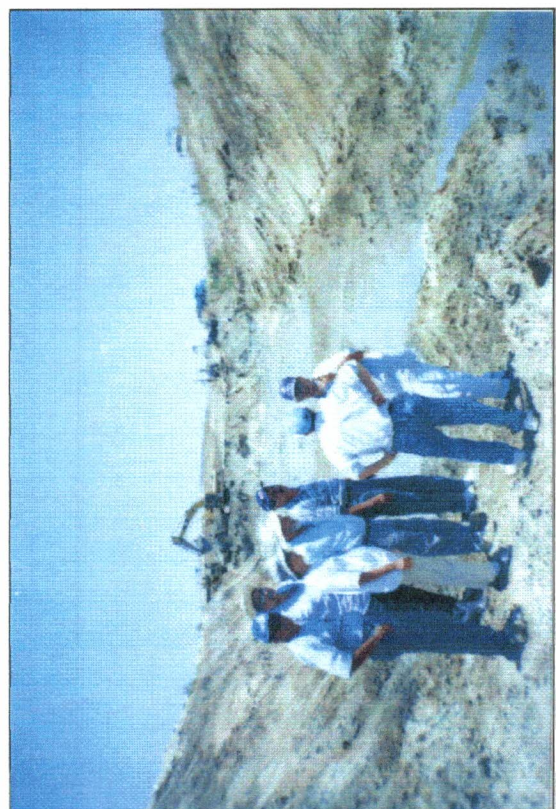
Fiscalização da SRH, observando a escavação da parte central do cut-off.
